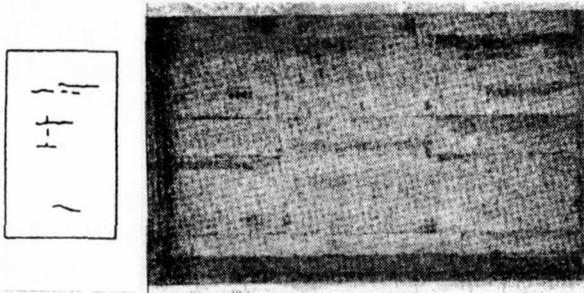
1方向のみのひび割れ<sup>31)</sup>
